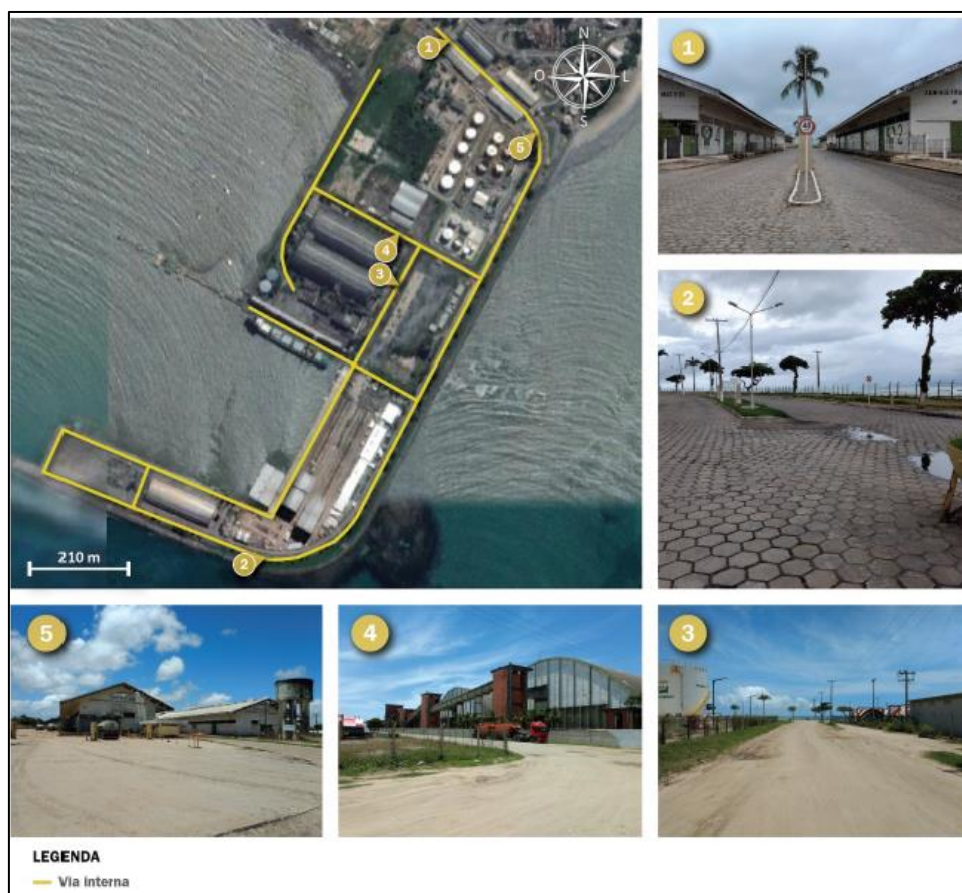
Condições de infraestrutura Plano Mestre Elaboração LabTrans/UFSC (2019).
